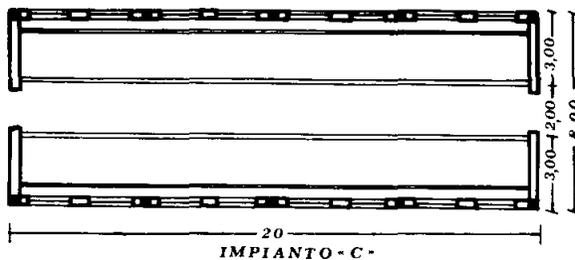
PLANIMETRIE DELLE STALLE, CON IMPIANTO DI MUNGITURA A SECCHIO ALLE POSTE.
